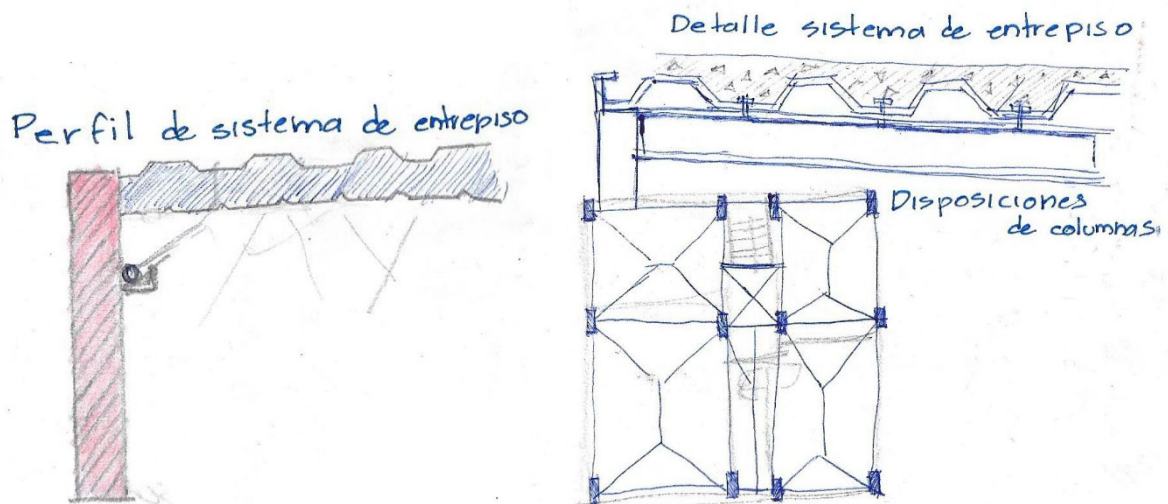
Definición de método constructivo, vista en corte. Disposición de columnas ejercicio en planta.
